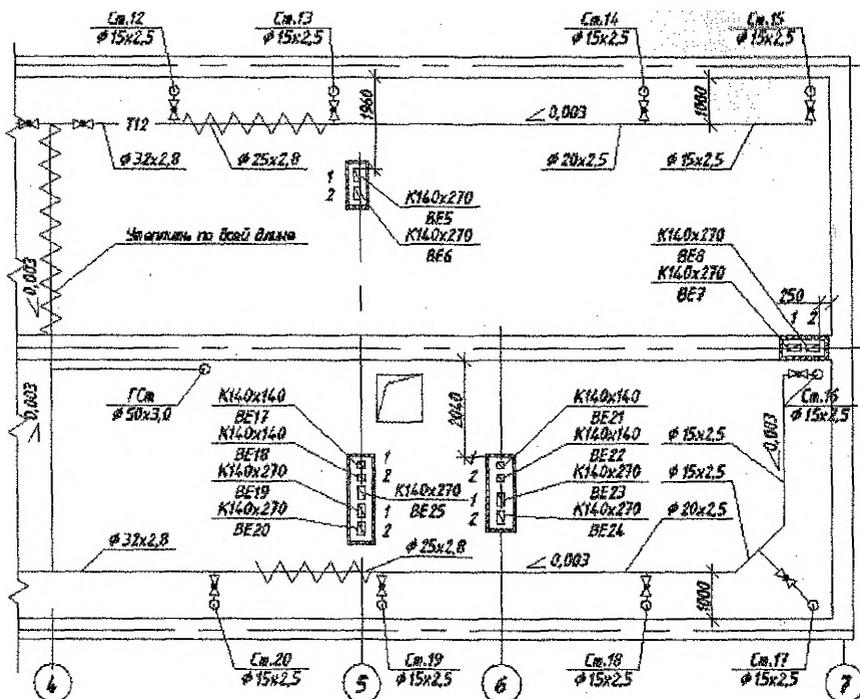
Пример расположения элементов системы отопления и вентиляции на плане подвала
